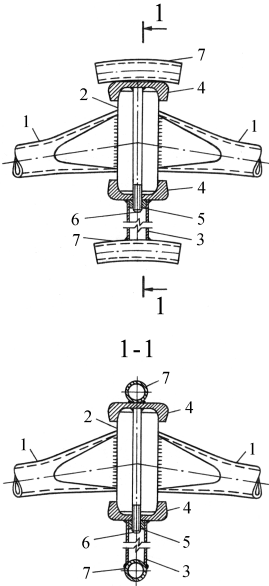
Схема вузла покриття: 1 – стержні; 2 – наконечники; 3 – оболонка; 4 – диски; 5 – гайка; 6 – болт; 7 – відрізки труби
